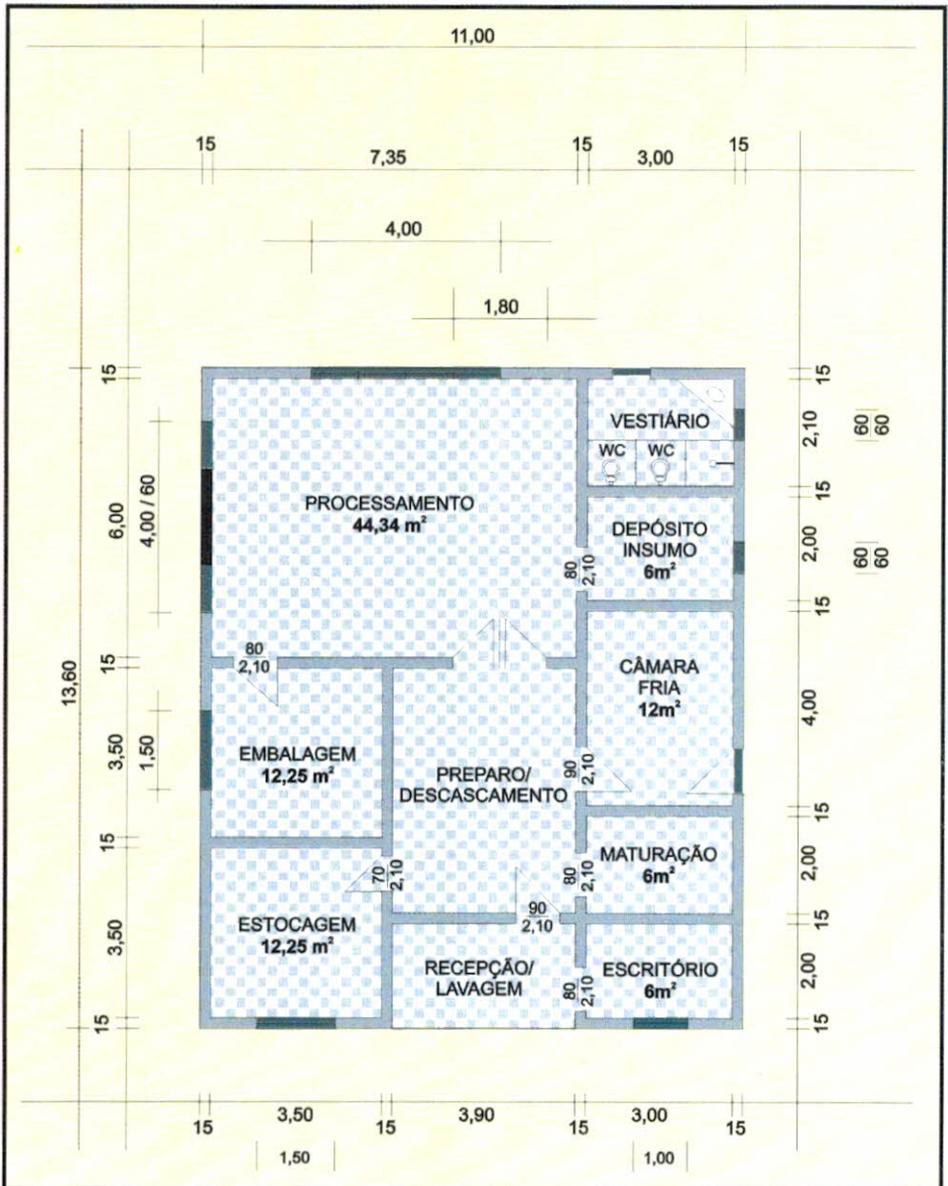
Planta de agroindústria artesanal. Técnico Responsável: Ercília Bueno Bassani – CRED – 0056 (planta fora de escala)
